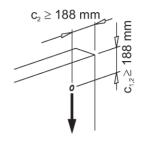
Einbausituation Wandfläche - Zugbeanspruchung, ohne Rückhängwebewehrung
